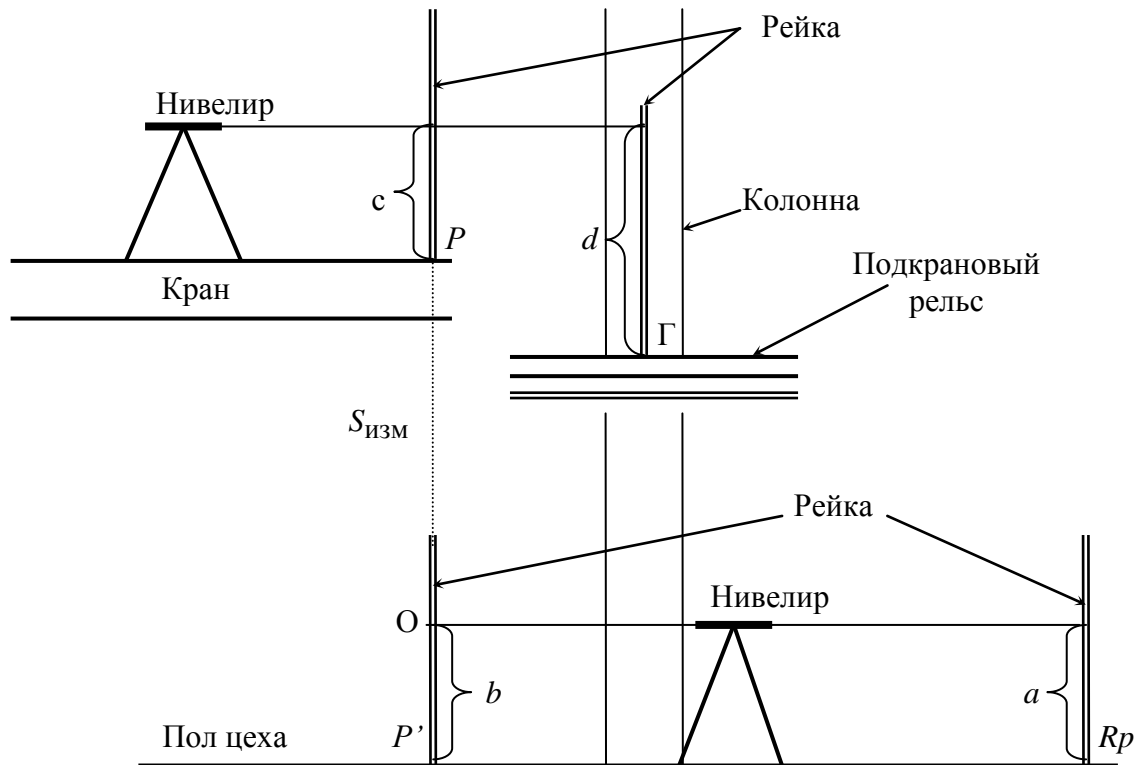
Схема передачи отметки с помощью нивелира и лазерной рулетки
